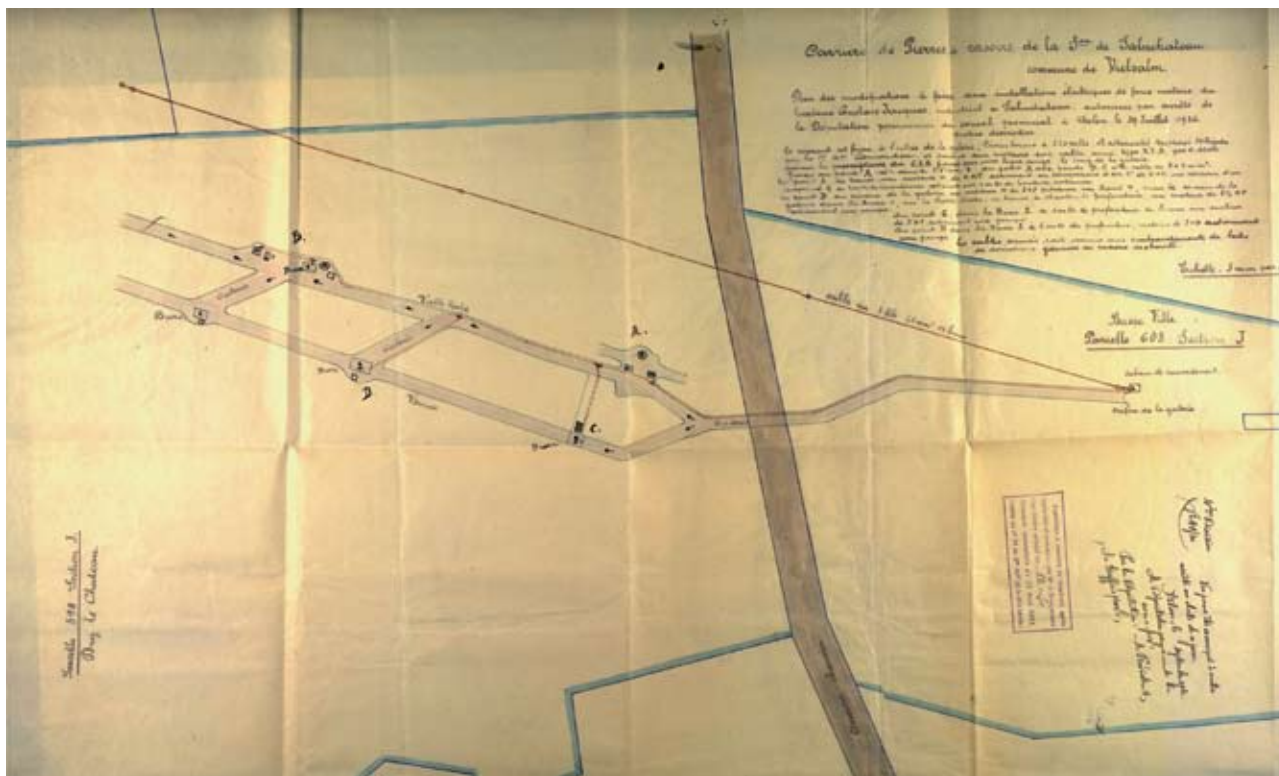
Plan de 1926 d'une carrière souterraine de Pierres à rasoir de la Section de Salmchâteau et louée par Gustave Jacques. Archives de l'Etat à Arlon.
